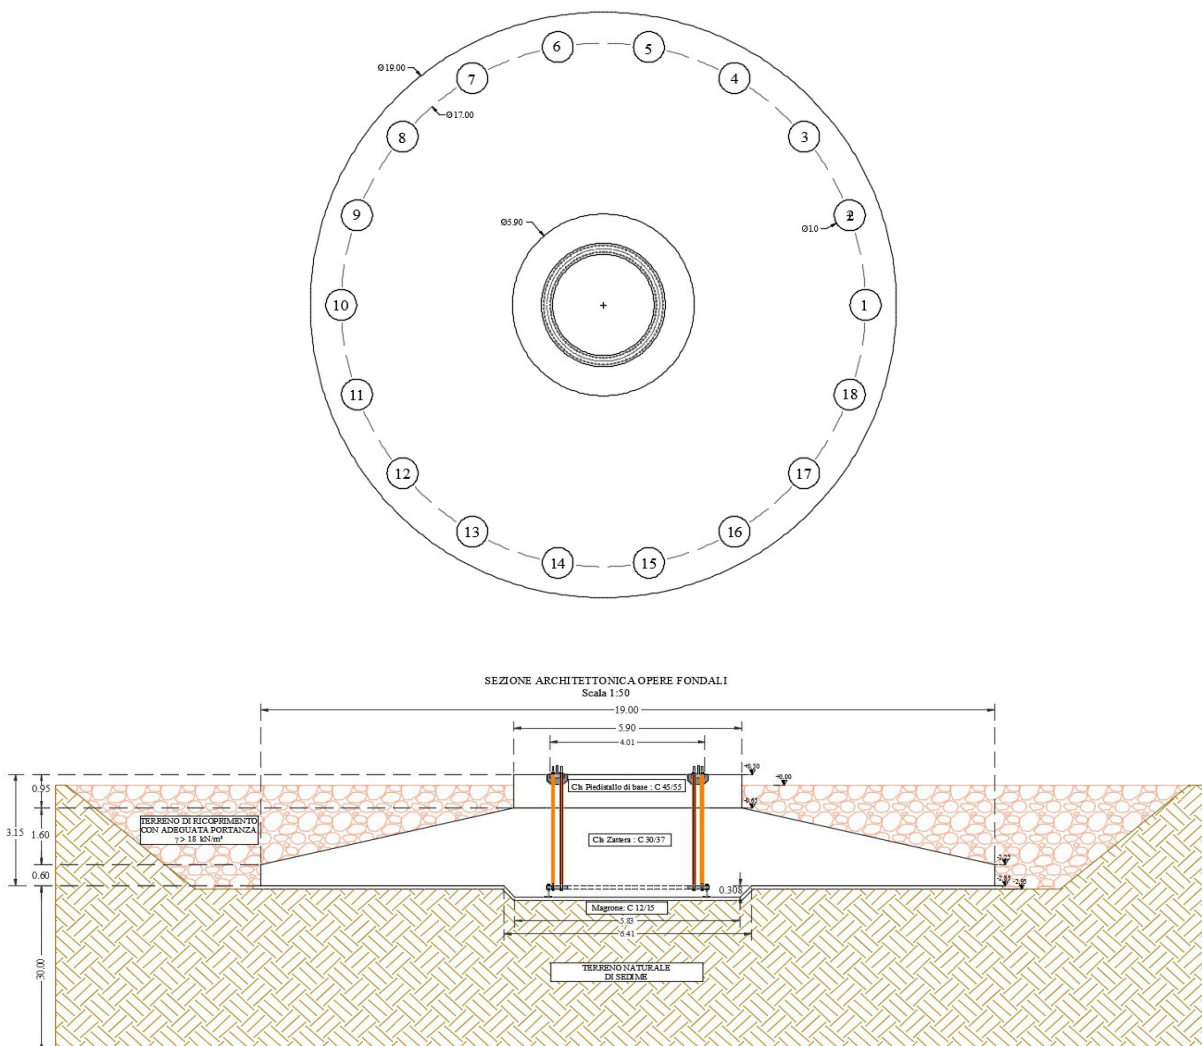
Pianta architettonica e sezione delle fondazioni dell'aerogeneratore con caratteristiche geometriche
